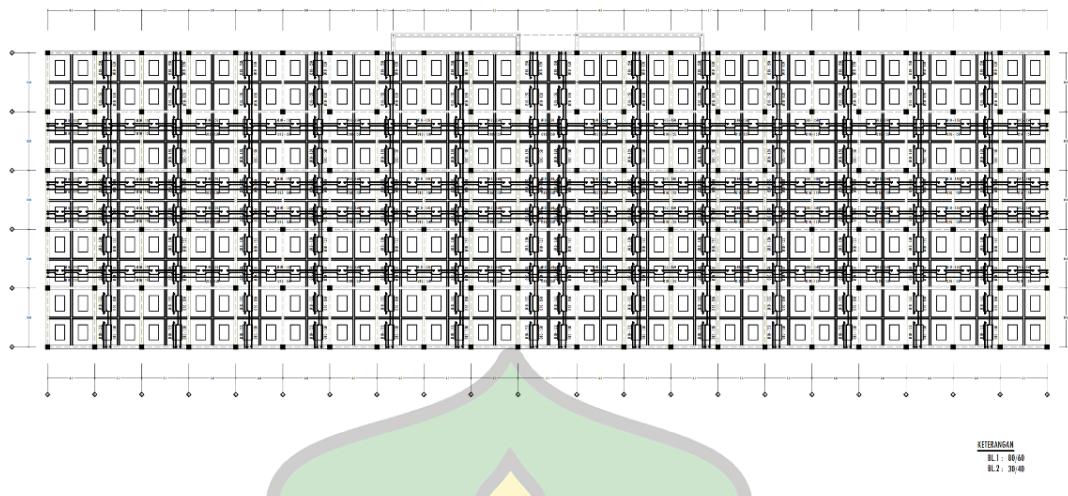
Denah Plat Lantai Convention Hall
